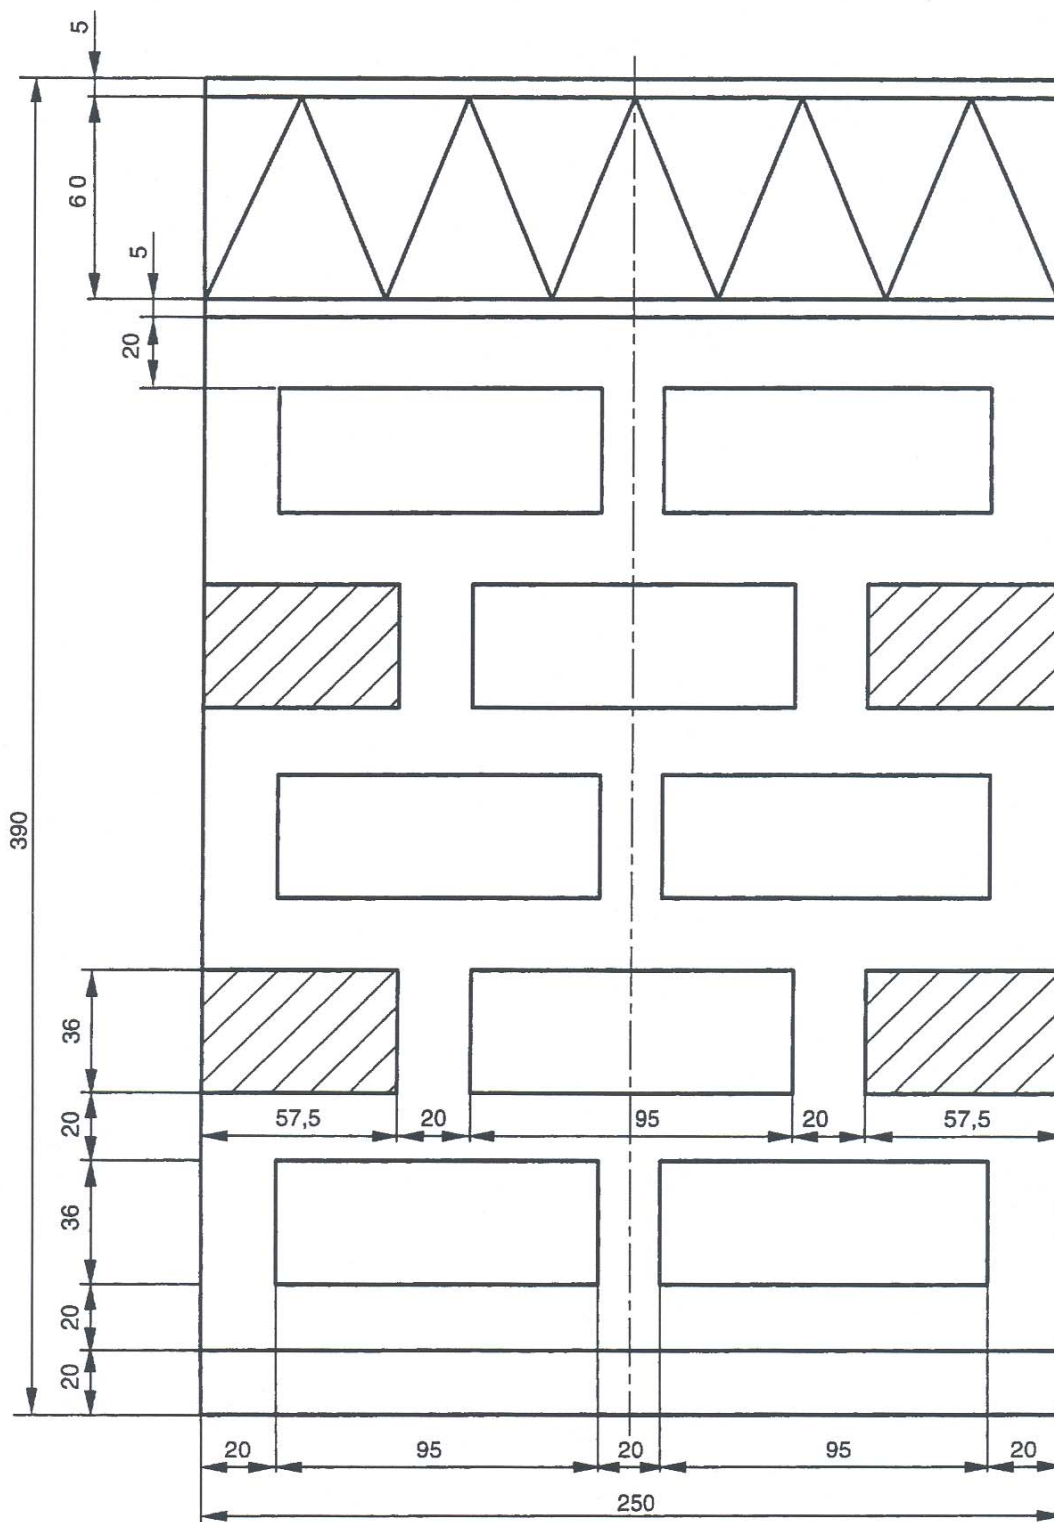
Geometria de uma unidade de tijolos montados com cimento
